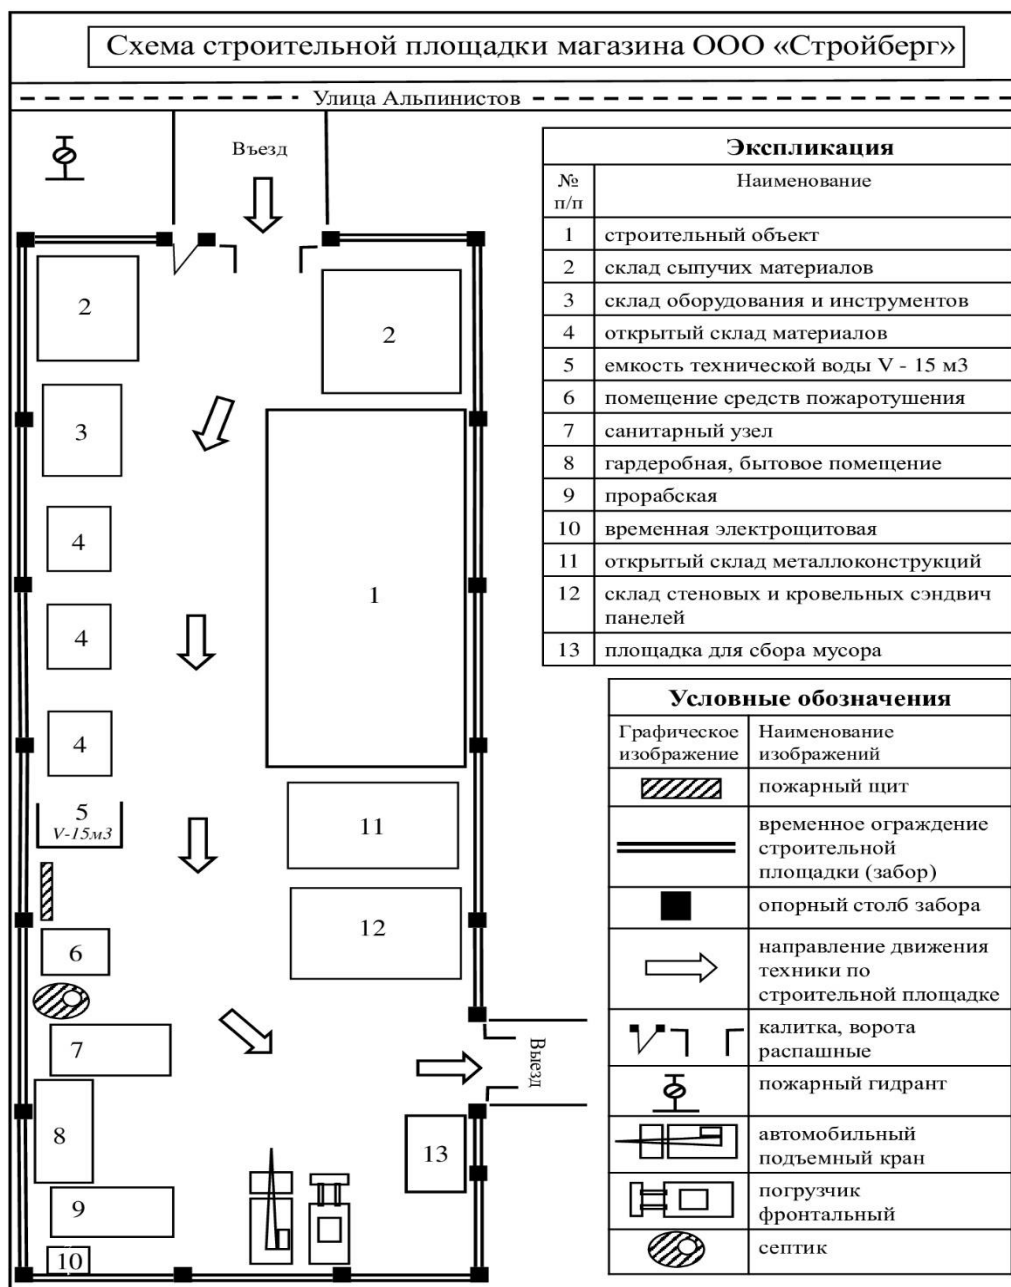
Схема строительной площадки магазина ООО «Стройберг»
